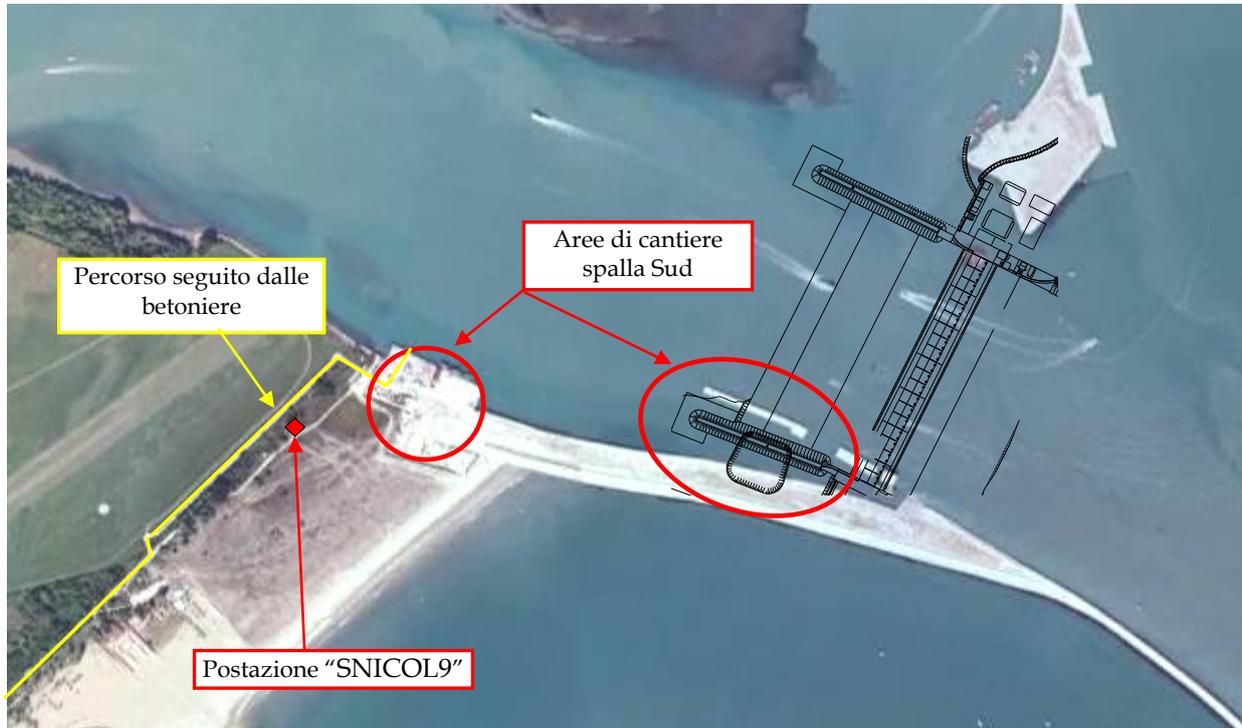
Individuazione della postazione di misura SNICOL9, delle aree di lavorazione presso il cantiere della spalla Sud, e del tragitto percorso dalle betoniere.
